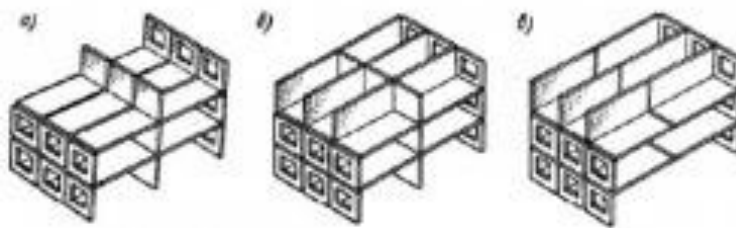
Конструктивные стены бескаркасных крупнопанельных зданий
